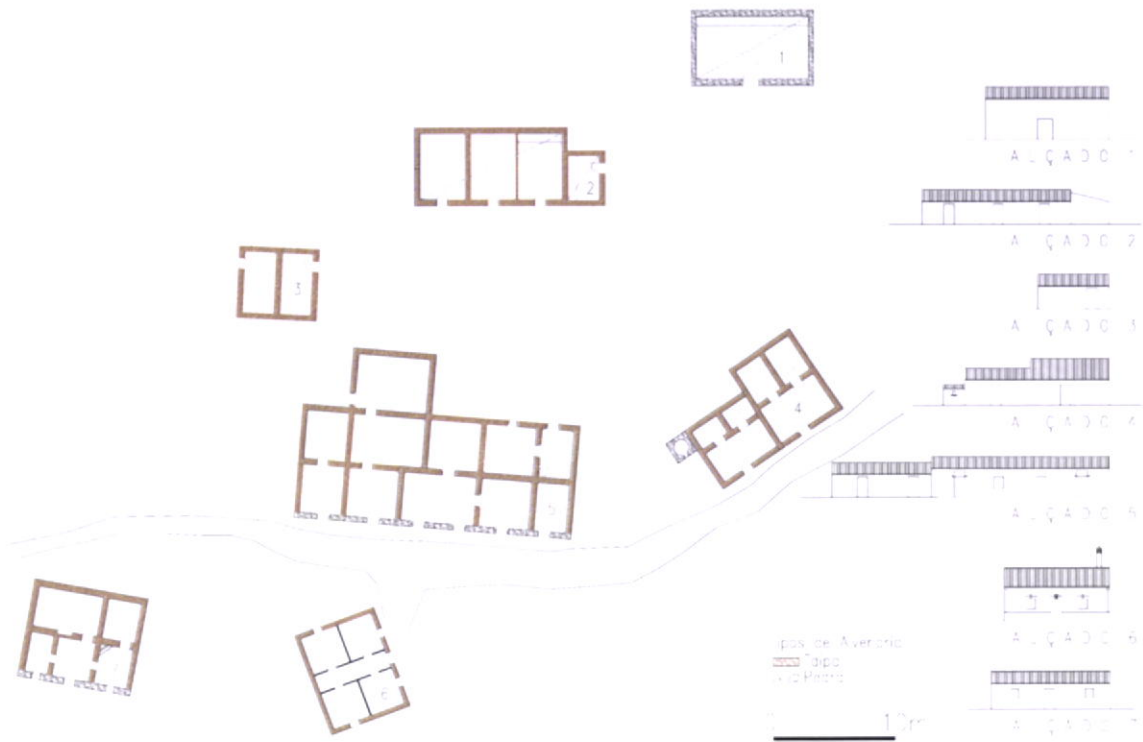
Tojeiro, monte de grande dimensão composto por casas dispersas em taipa, alvenaria de pedra e alvenaria de tijolo. Planta e alçados.
